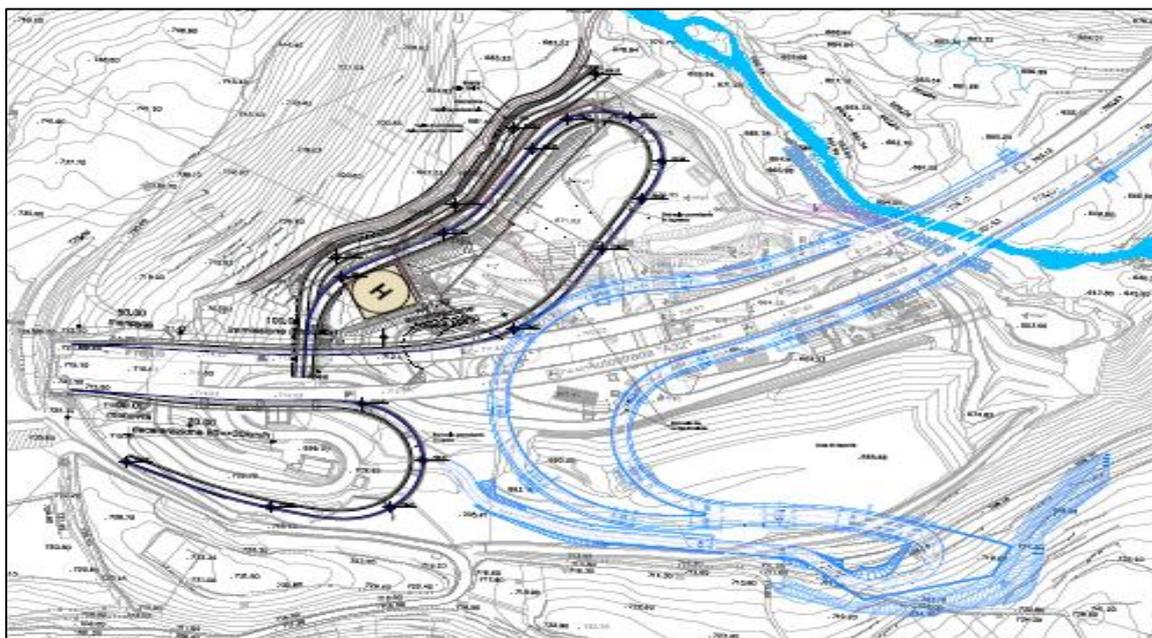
Rampe provvisorie da/per Bardonecchia con svincolo nella configurazione del Progetto Definitivo approvato
